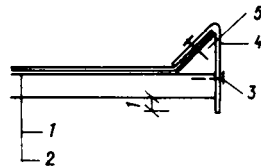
Край кровли из однослойного толя с использованием трехгранной планки
